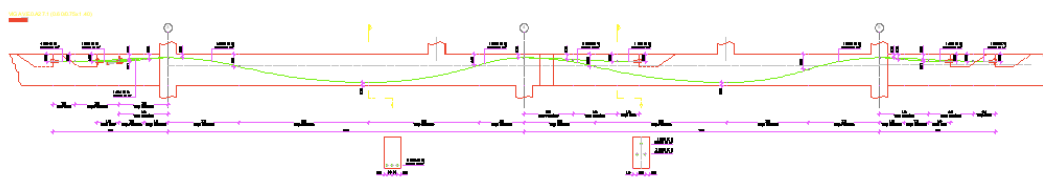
Exemplo de traçado de pré-esforço previsto em projeto
